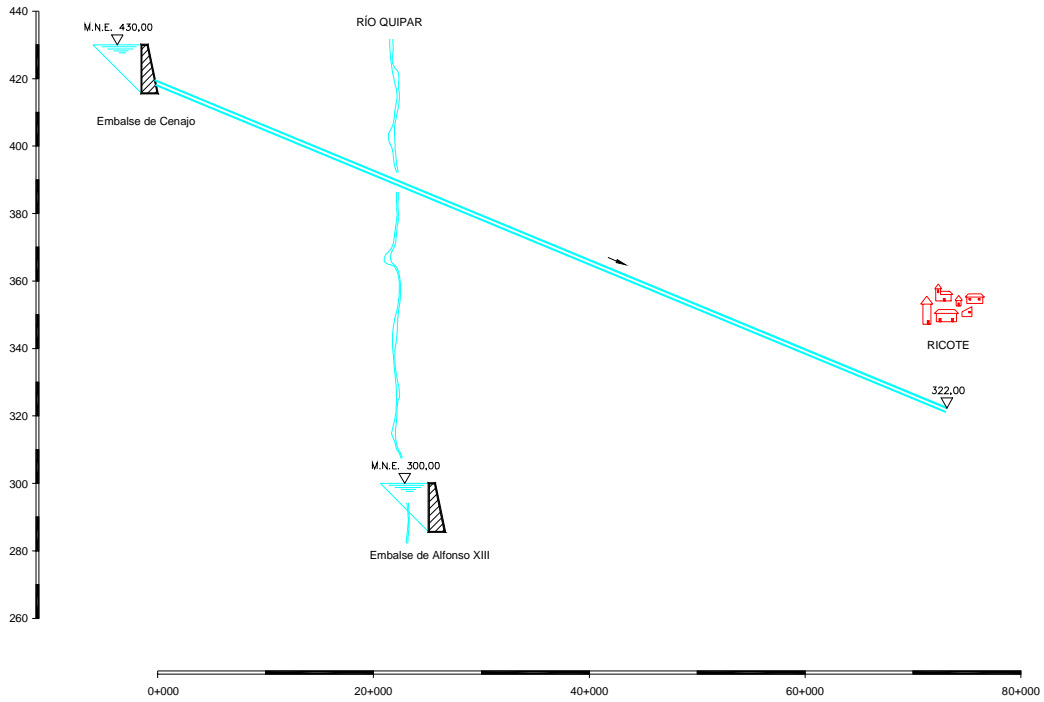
Conducción Cenajo-Ricote. Esquema en alzado
